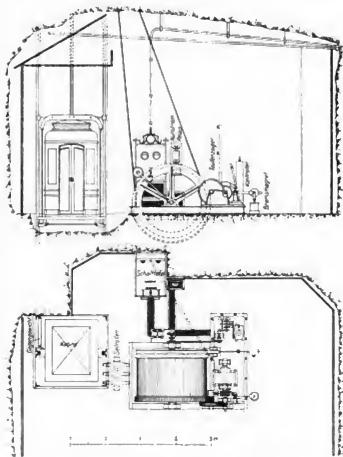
Die Maschinenkammer mit der Aufzugswinde-Einrichtung.
